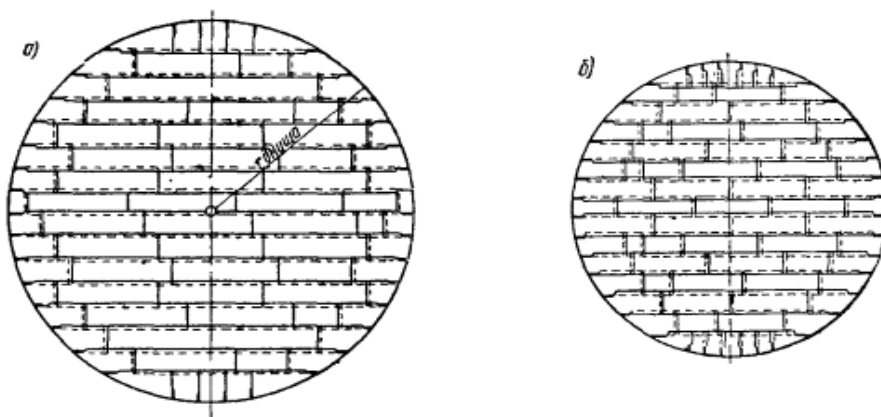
Конструкция плоского днища вертикального цилиндрического резервуара
